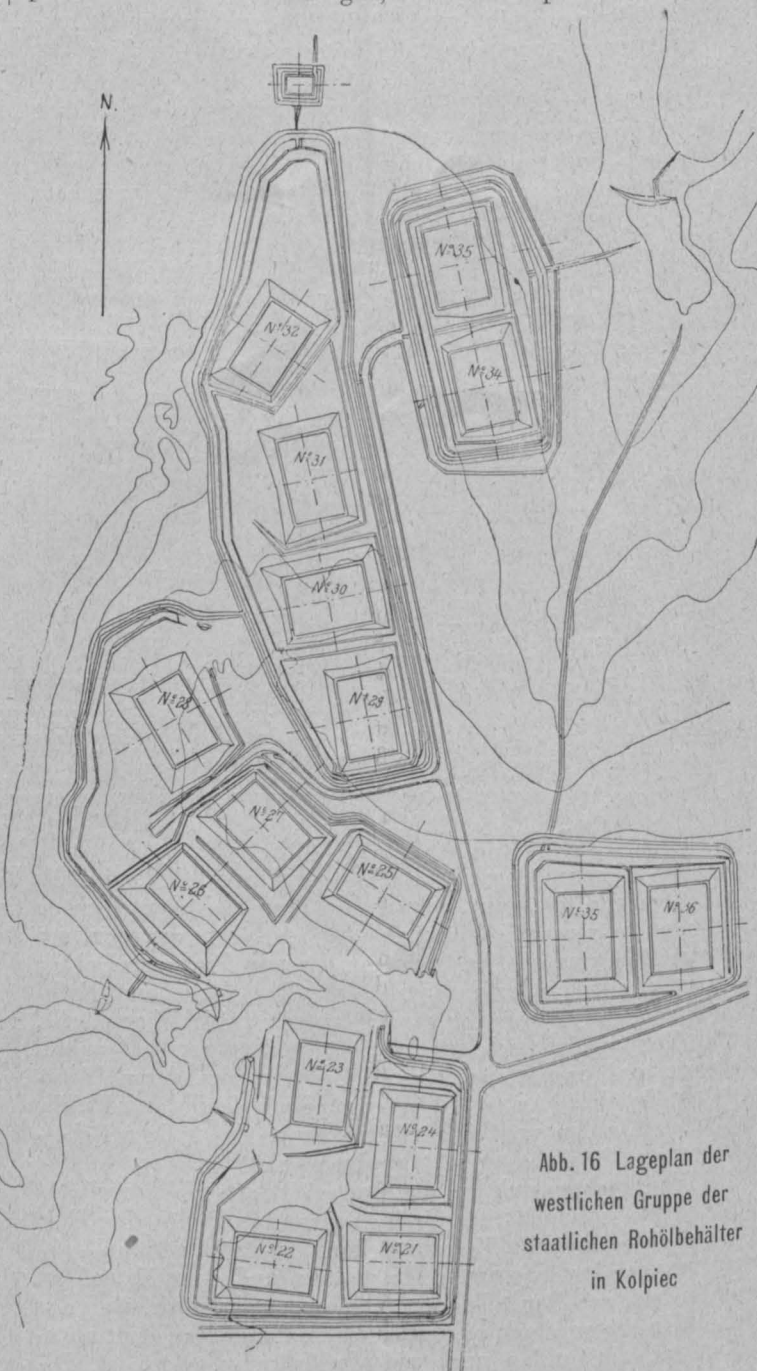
Lageplan der westlichen Gruppe der staatlichen Rohölbehälter in Kolpiec
